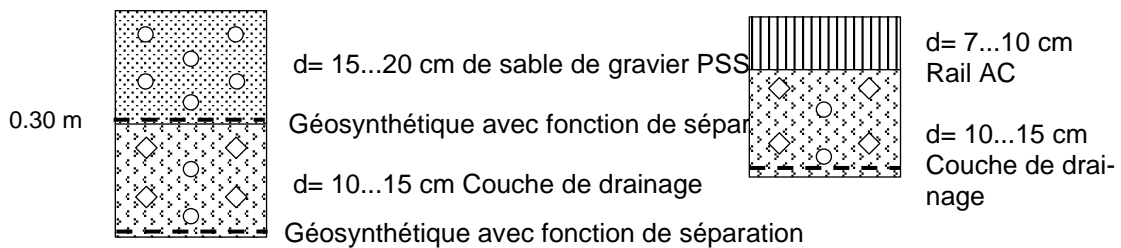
Structures de profilés sandwich avec sable à graviers PSS et AC Rail
